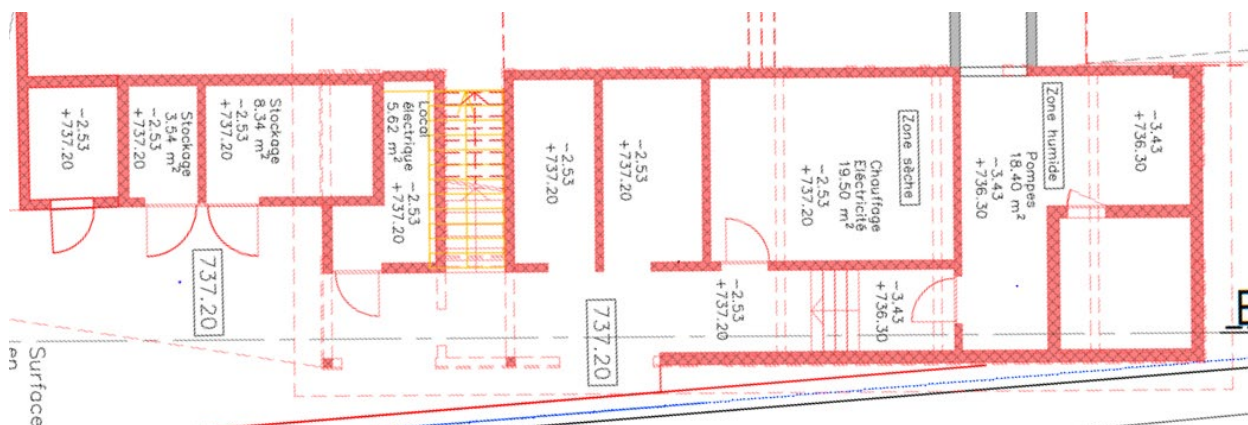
Bâtiment B, rez-de-chaussée inférieure
